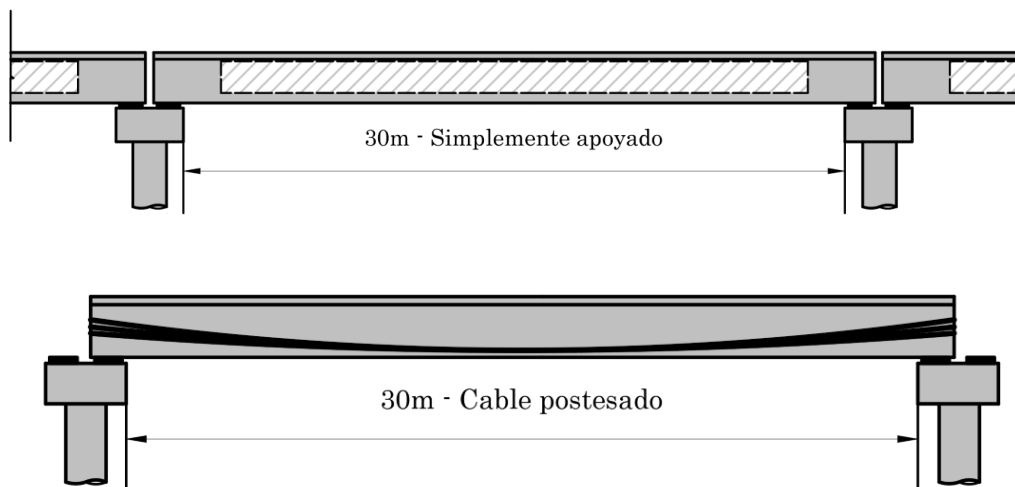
Sección longitudinal de la viga cajón multicelular del caso de estudio. Cable postesado (Fuente: Elaboración propia).
